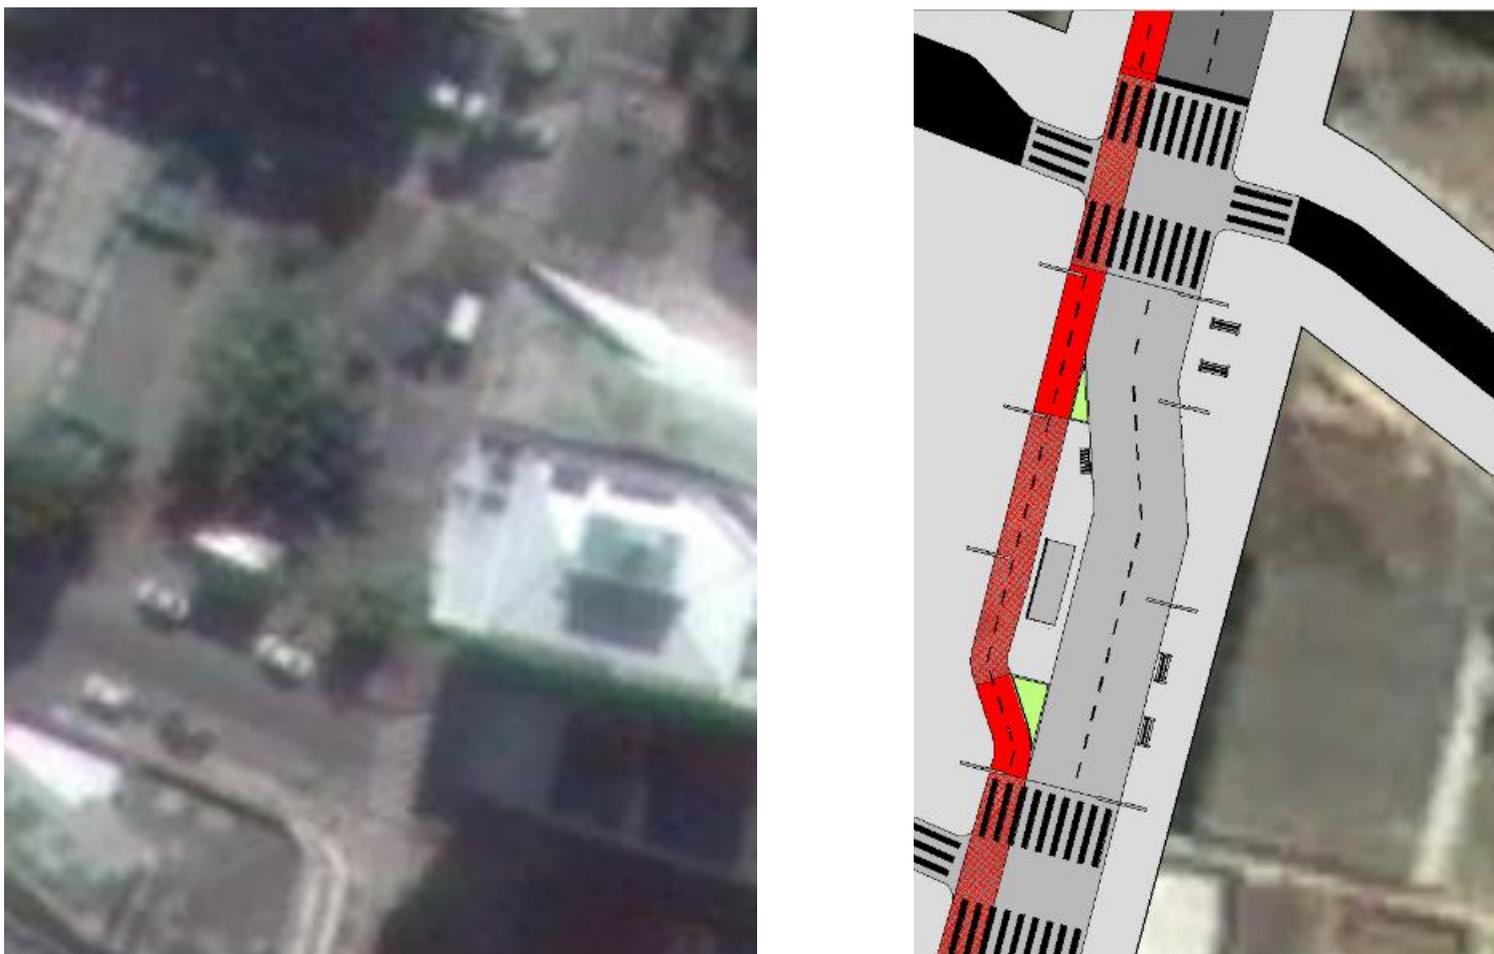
Imagem aérea e planta ilustrada com a proposta para a da Rua Santana, em Santo Amaro da Imperatriz.
